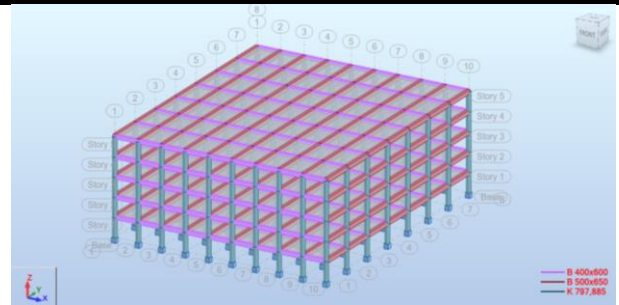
3D Gedung dengan Kolom Persegi Panjang
